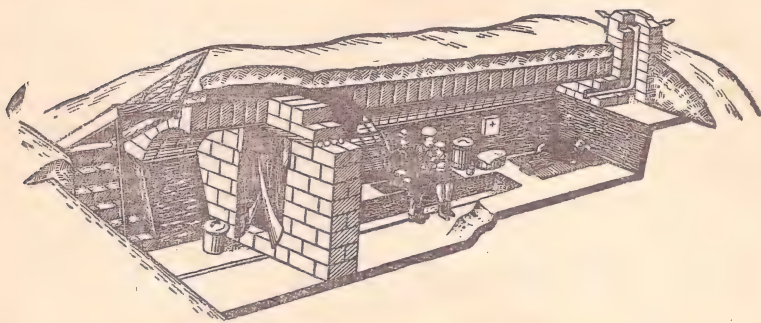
Укрытие без одежды крутостей со сводом из саманных (грунтовых) блоков (ослабляет действие радиации в 400—600 раз; устраивается в южных безлесных районах)
